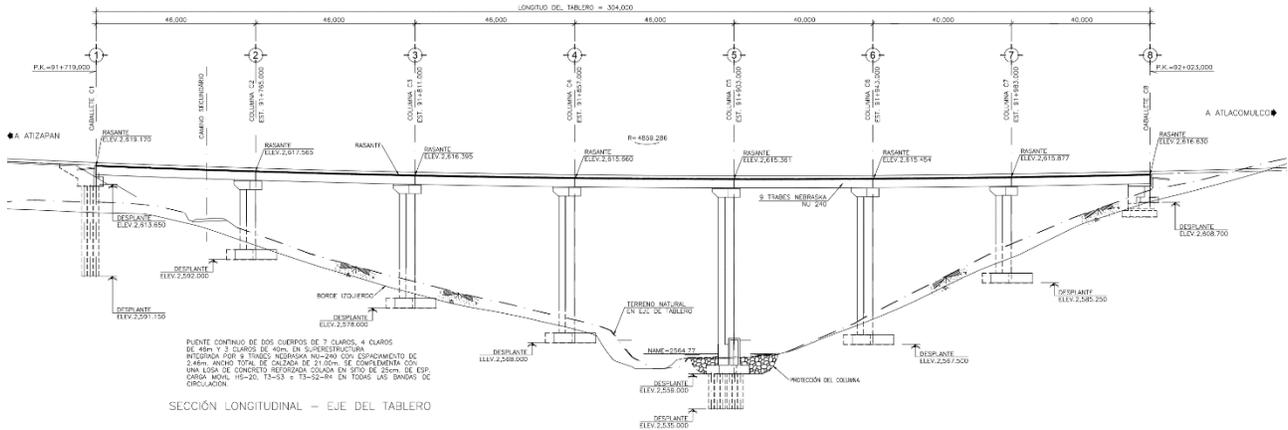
Sección longitudinal del viaducto "El salto" CAD 91+874.00.
